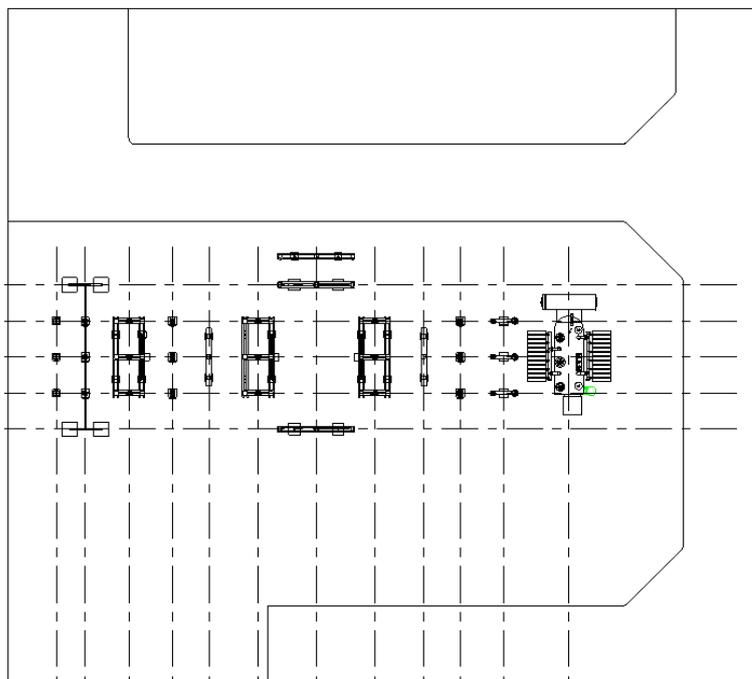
Planta del parque de Intemperie con los equipos colocados (Elaboración Propia)
